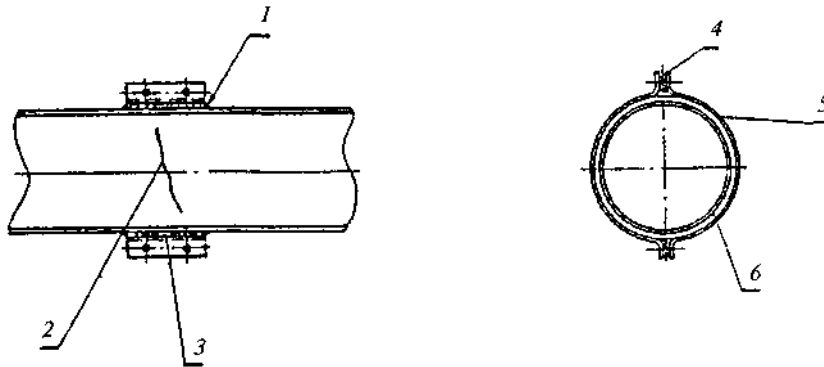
Схема заделки поперечных трещин на чугунных и стальных трубопроводах
